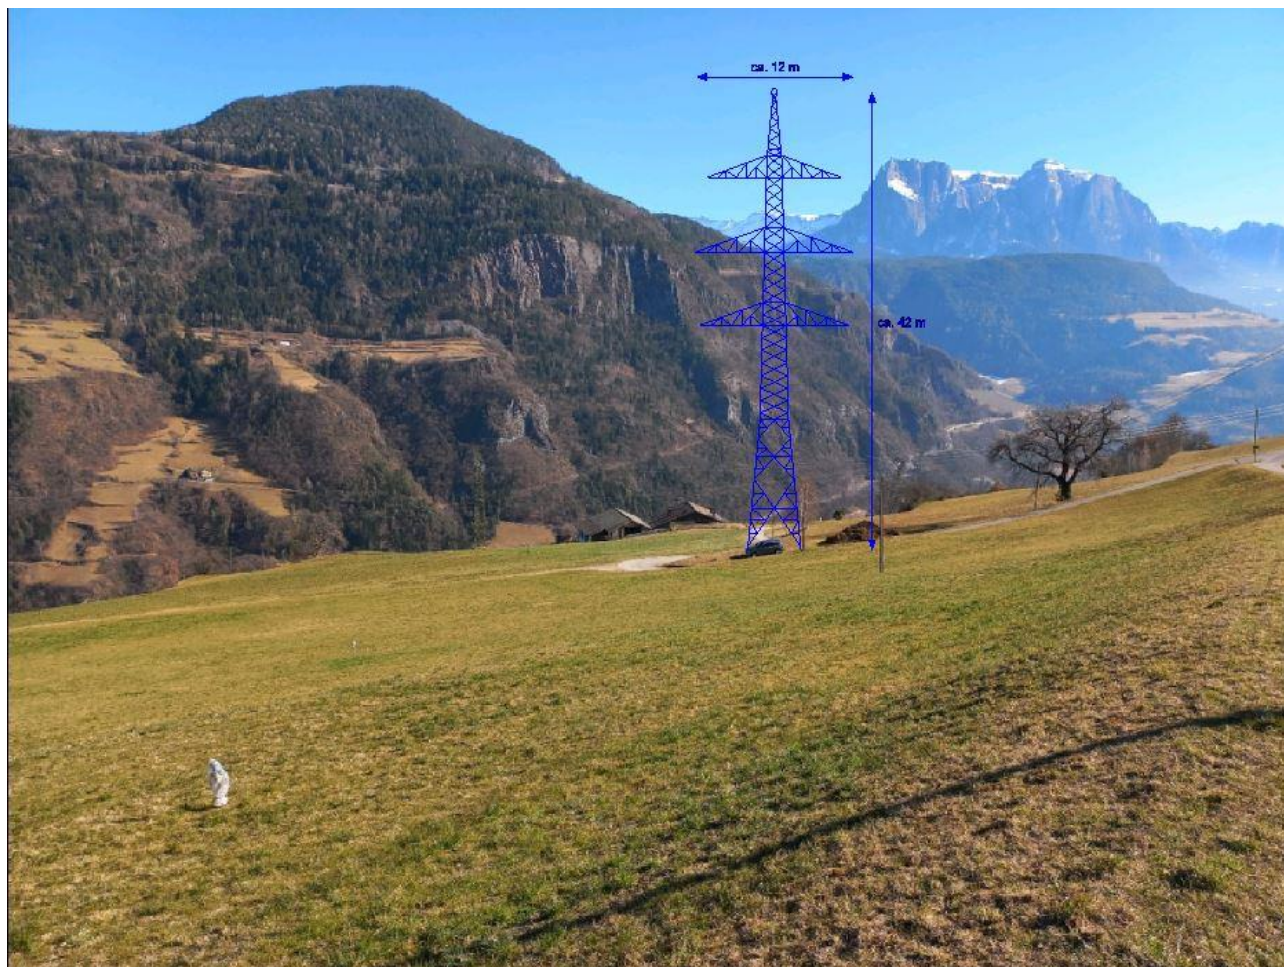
Vista verso SE paesaggio rurale interessato da DT 220/132 kV, con posizione sostegno n. 412
